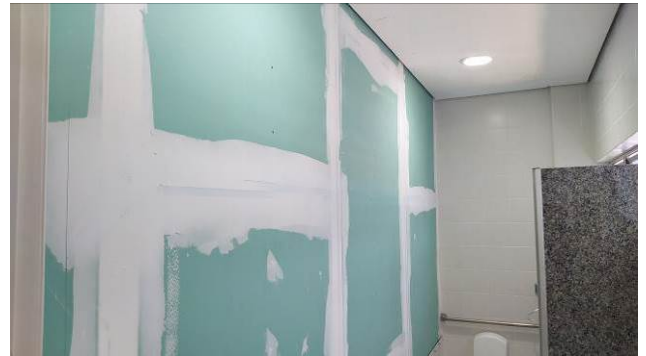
C: Parede de gesso acartonado verde, executada no BWC PNE do segundo pavimento. No detalhe o forro já reconstituído.
